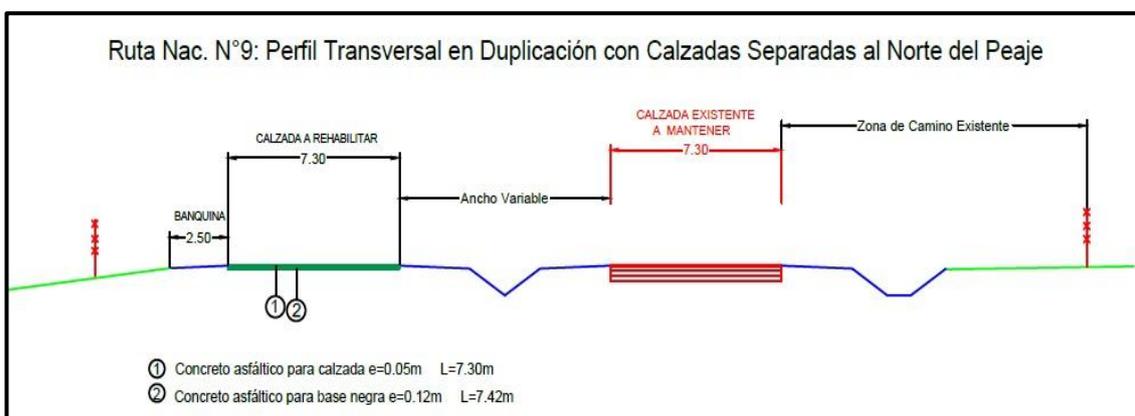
4 Perfil tipo proyectado (D.P.V.)
